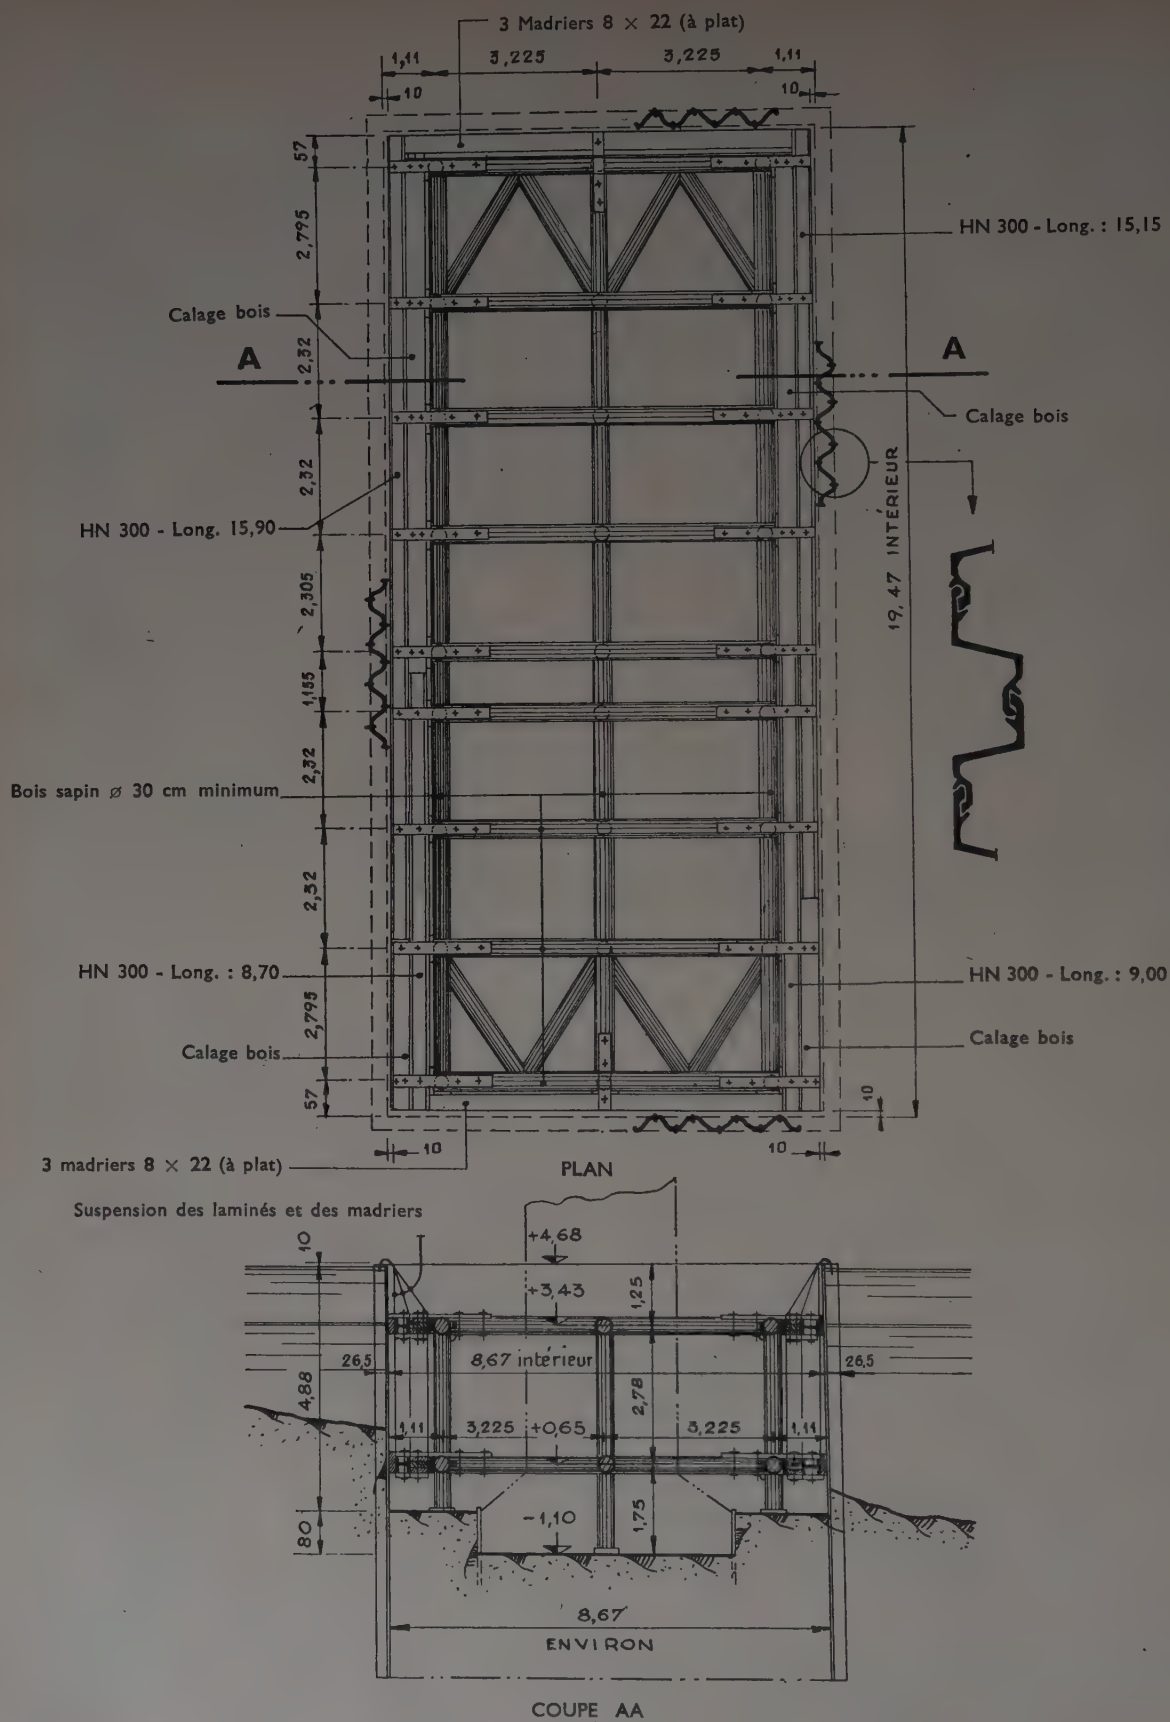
Cadrage d'une enceinte en palplanches métalliques.
